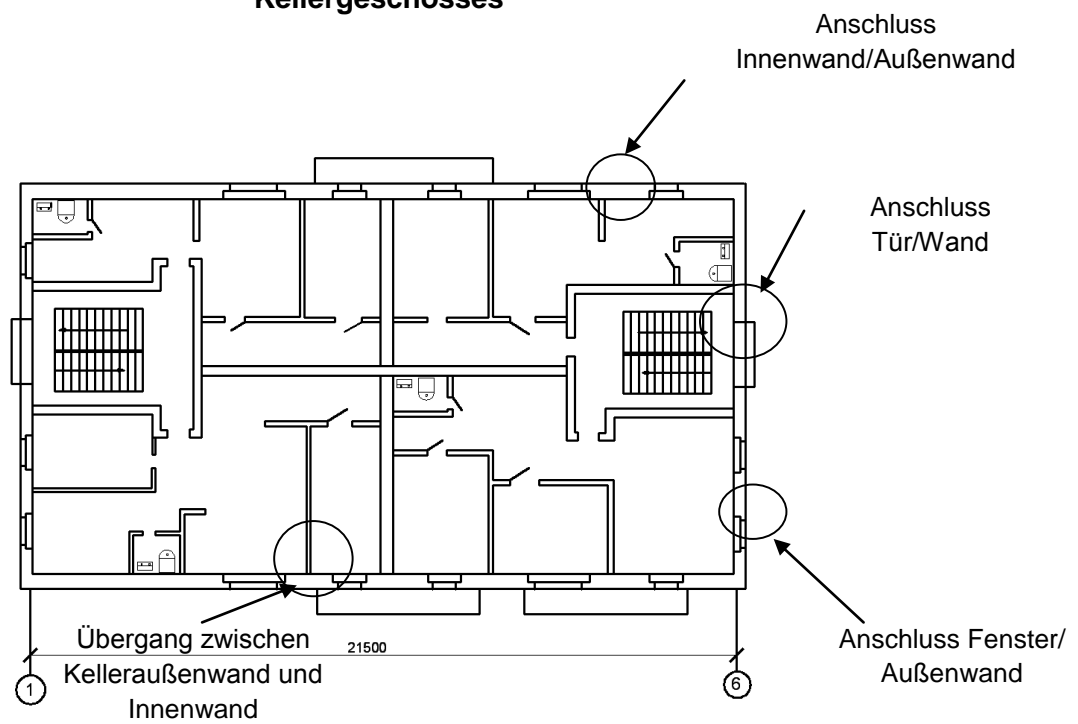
Gebäude in Plattenbauweise der 60-en XX: Grundriss eines Erdgeschoss
